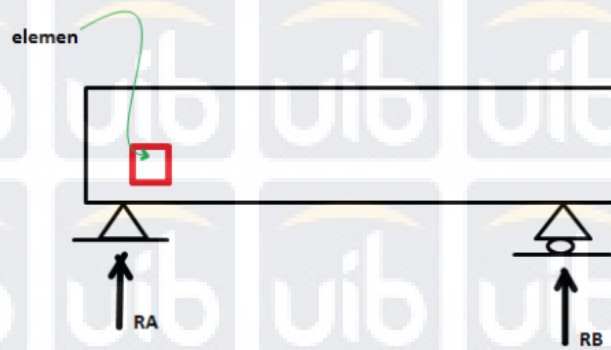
Skema Hitungan Momen Rencana Balok
